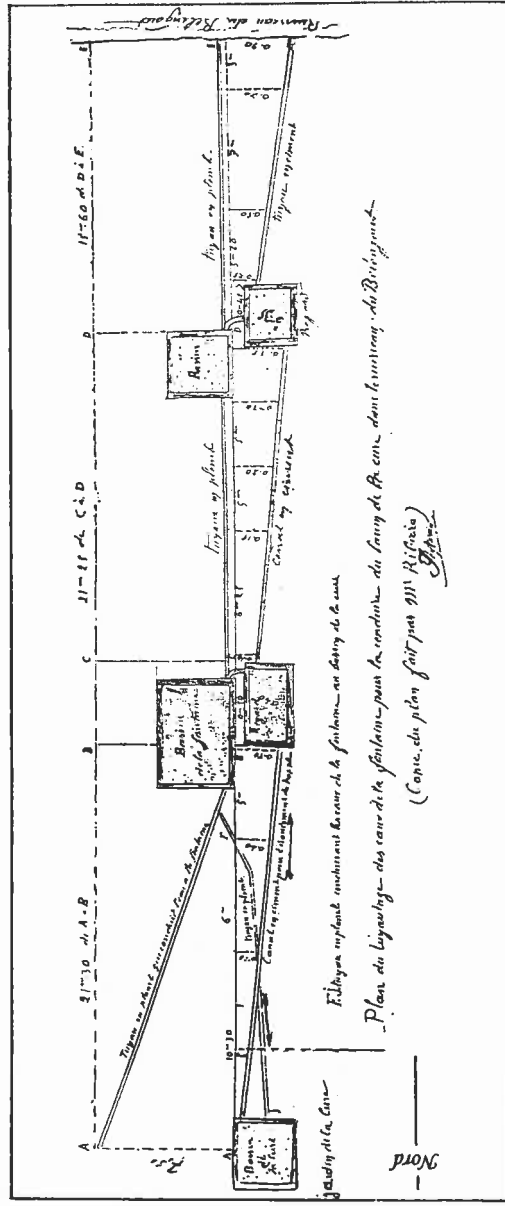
Plan des bassins, tuyaux, canaux et regards du jardin de l'abbaye, d'après le plan de M. Ribière (copie Peytavie, début du XX^e s.). Les eaux arrivent de Griffoul en A (en haut et à gauche du plan) et gagnent le Bélingou (à droite du plan).
